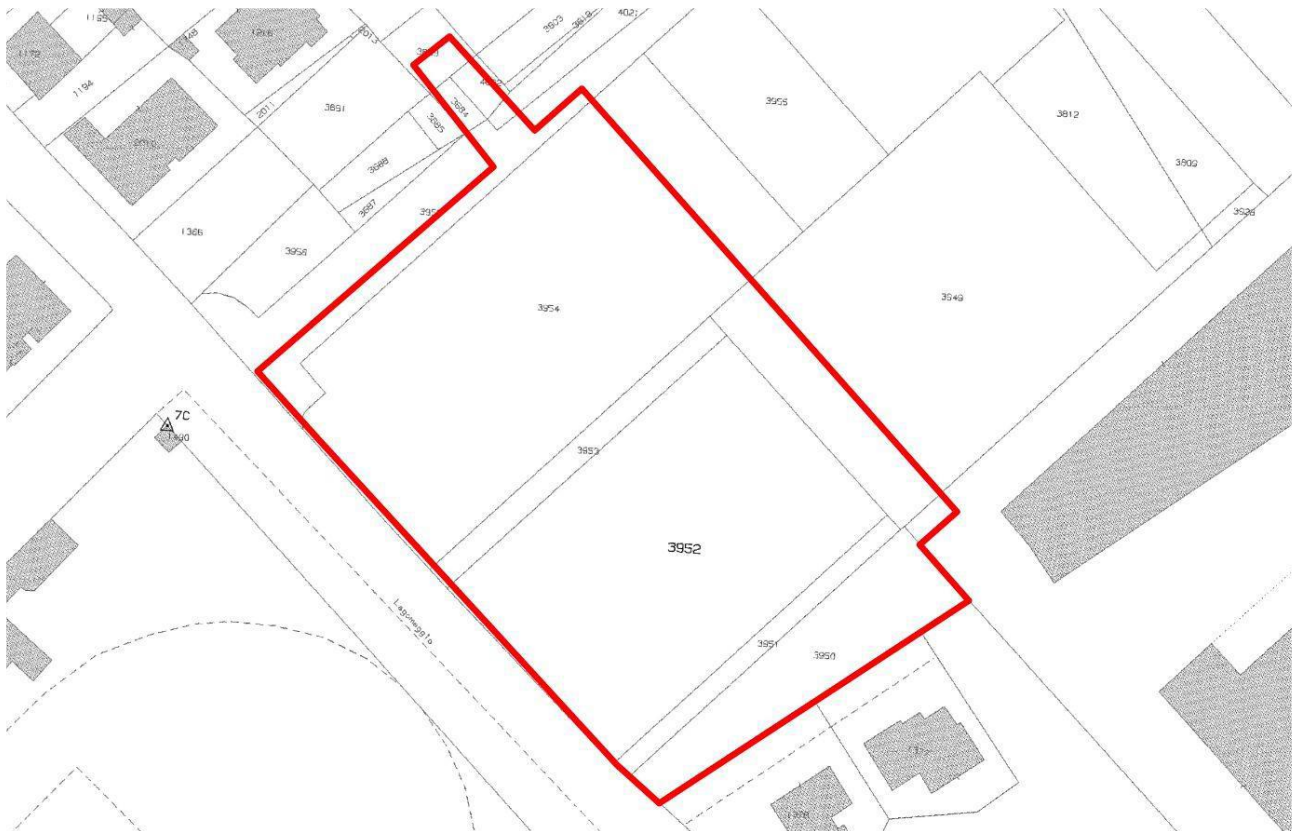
Planimetria catastale con sedime di progetto indicata in sede concorsuale
